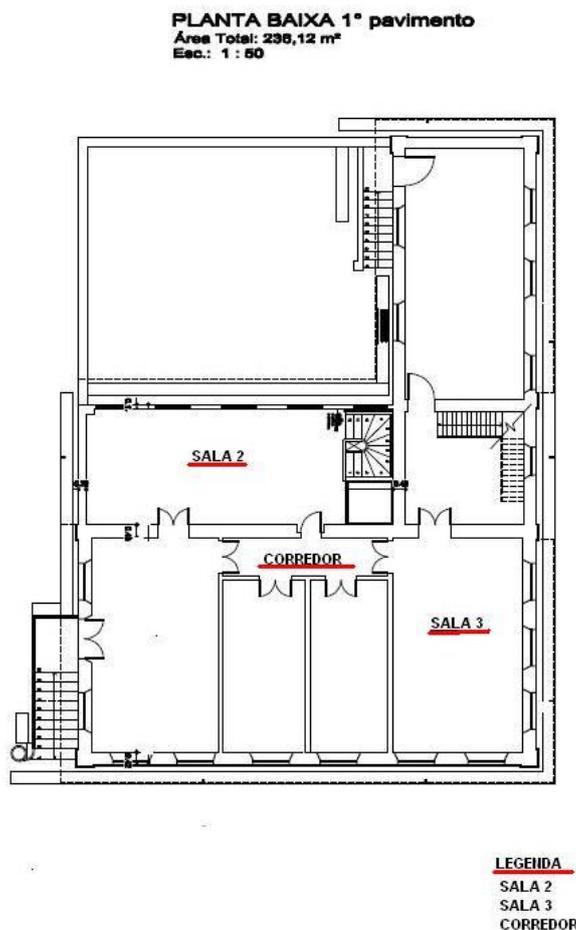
Planta baixa com a disposição inicial da exposição Transformações Urbanas - planta baixa do Solar Lopo Gonçalves
